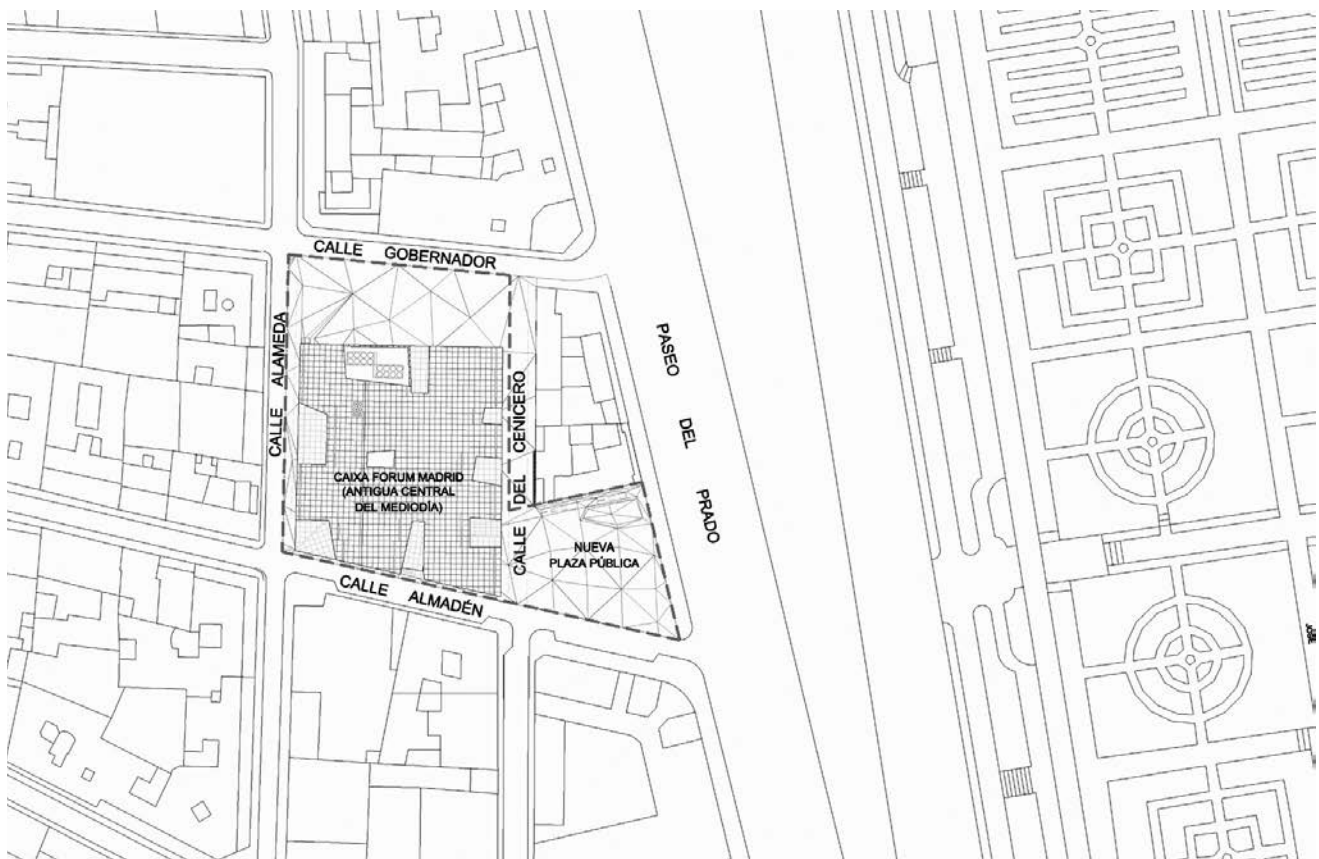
Planta de situación, conexión del nuevo edificio con el Paseo del Prado.
